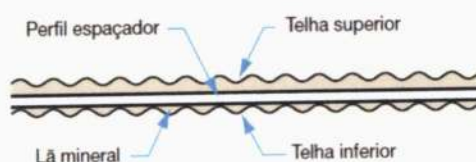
Telha Ondulada com Lâ Mineral (Fonte: ABCEM, 2009)
